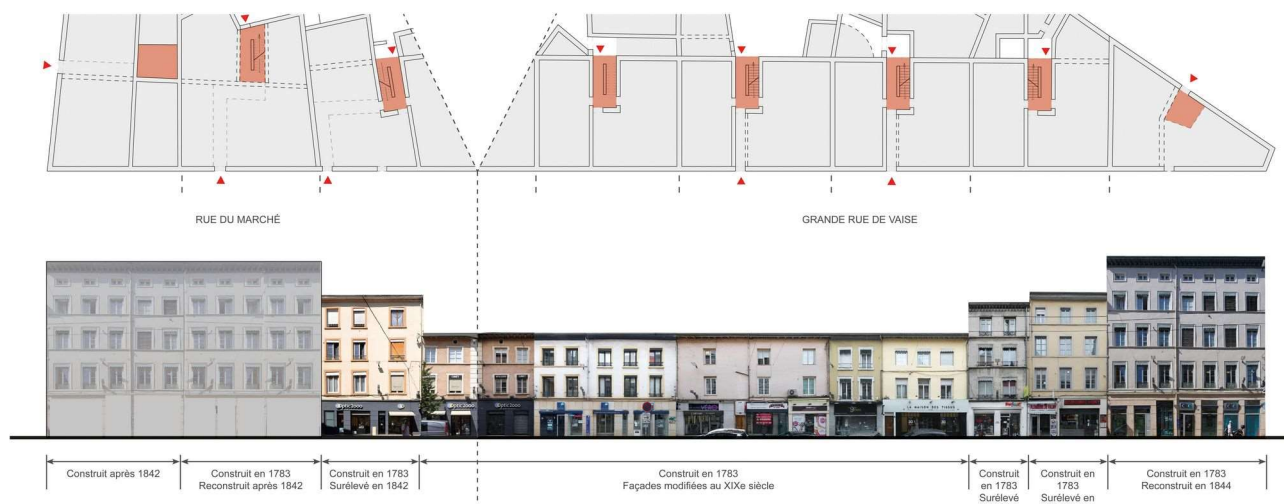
Plan de rez-de-chaussée de l'ancien ensemble de Vaise (état actuel) et développé des façades correspondantes avec synthèse des dates des principales modifications connues. Plan et vues redressées : E. Mille, d'après les photographies de l'Inventaire général du patrimoine, in : Delavenne, Mille, 2022.
